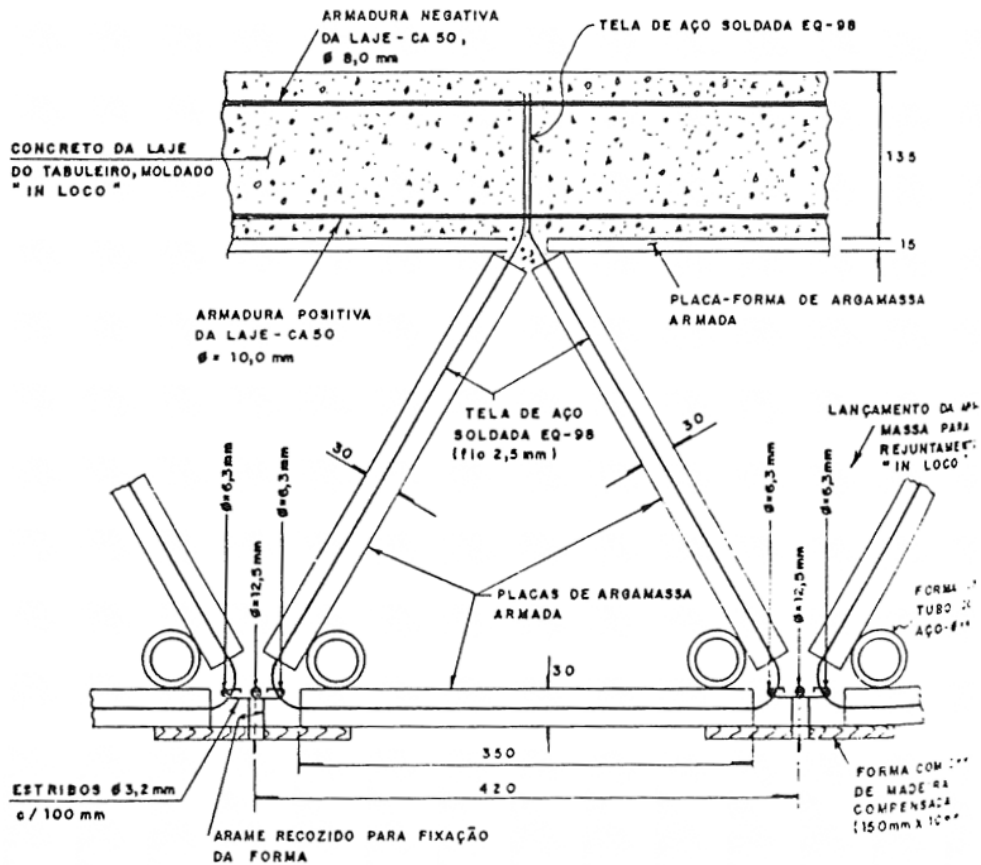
Esquema transversal das ligações estruturais (medidas em mm)
